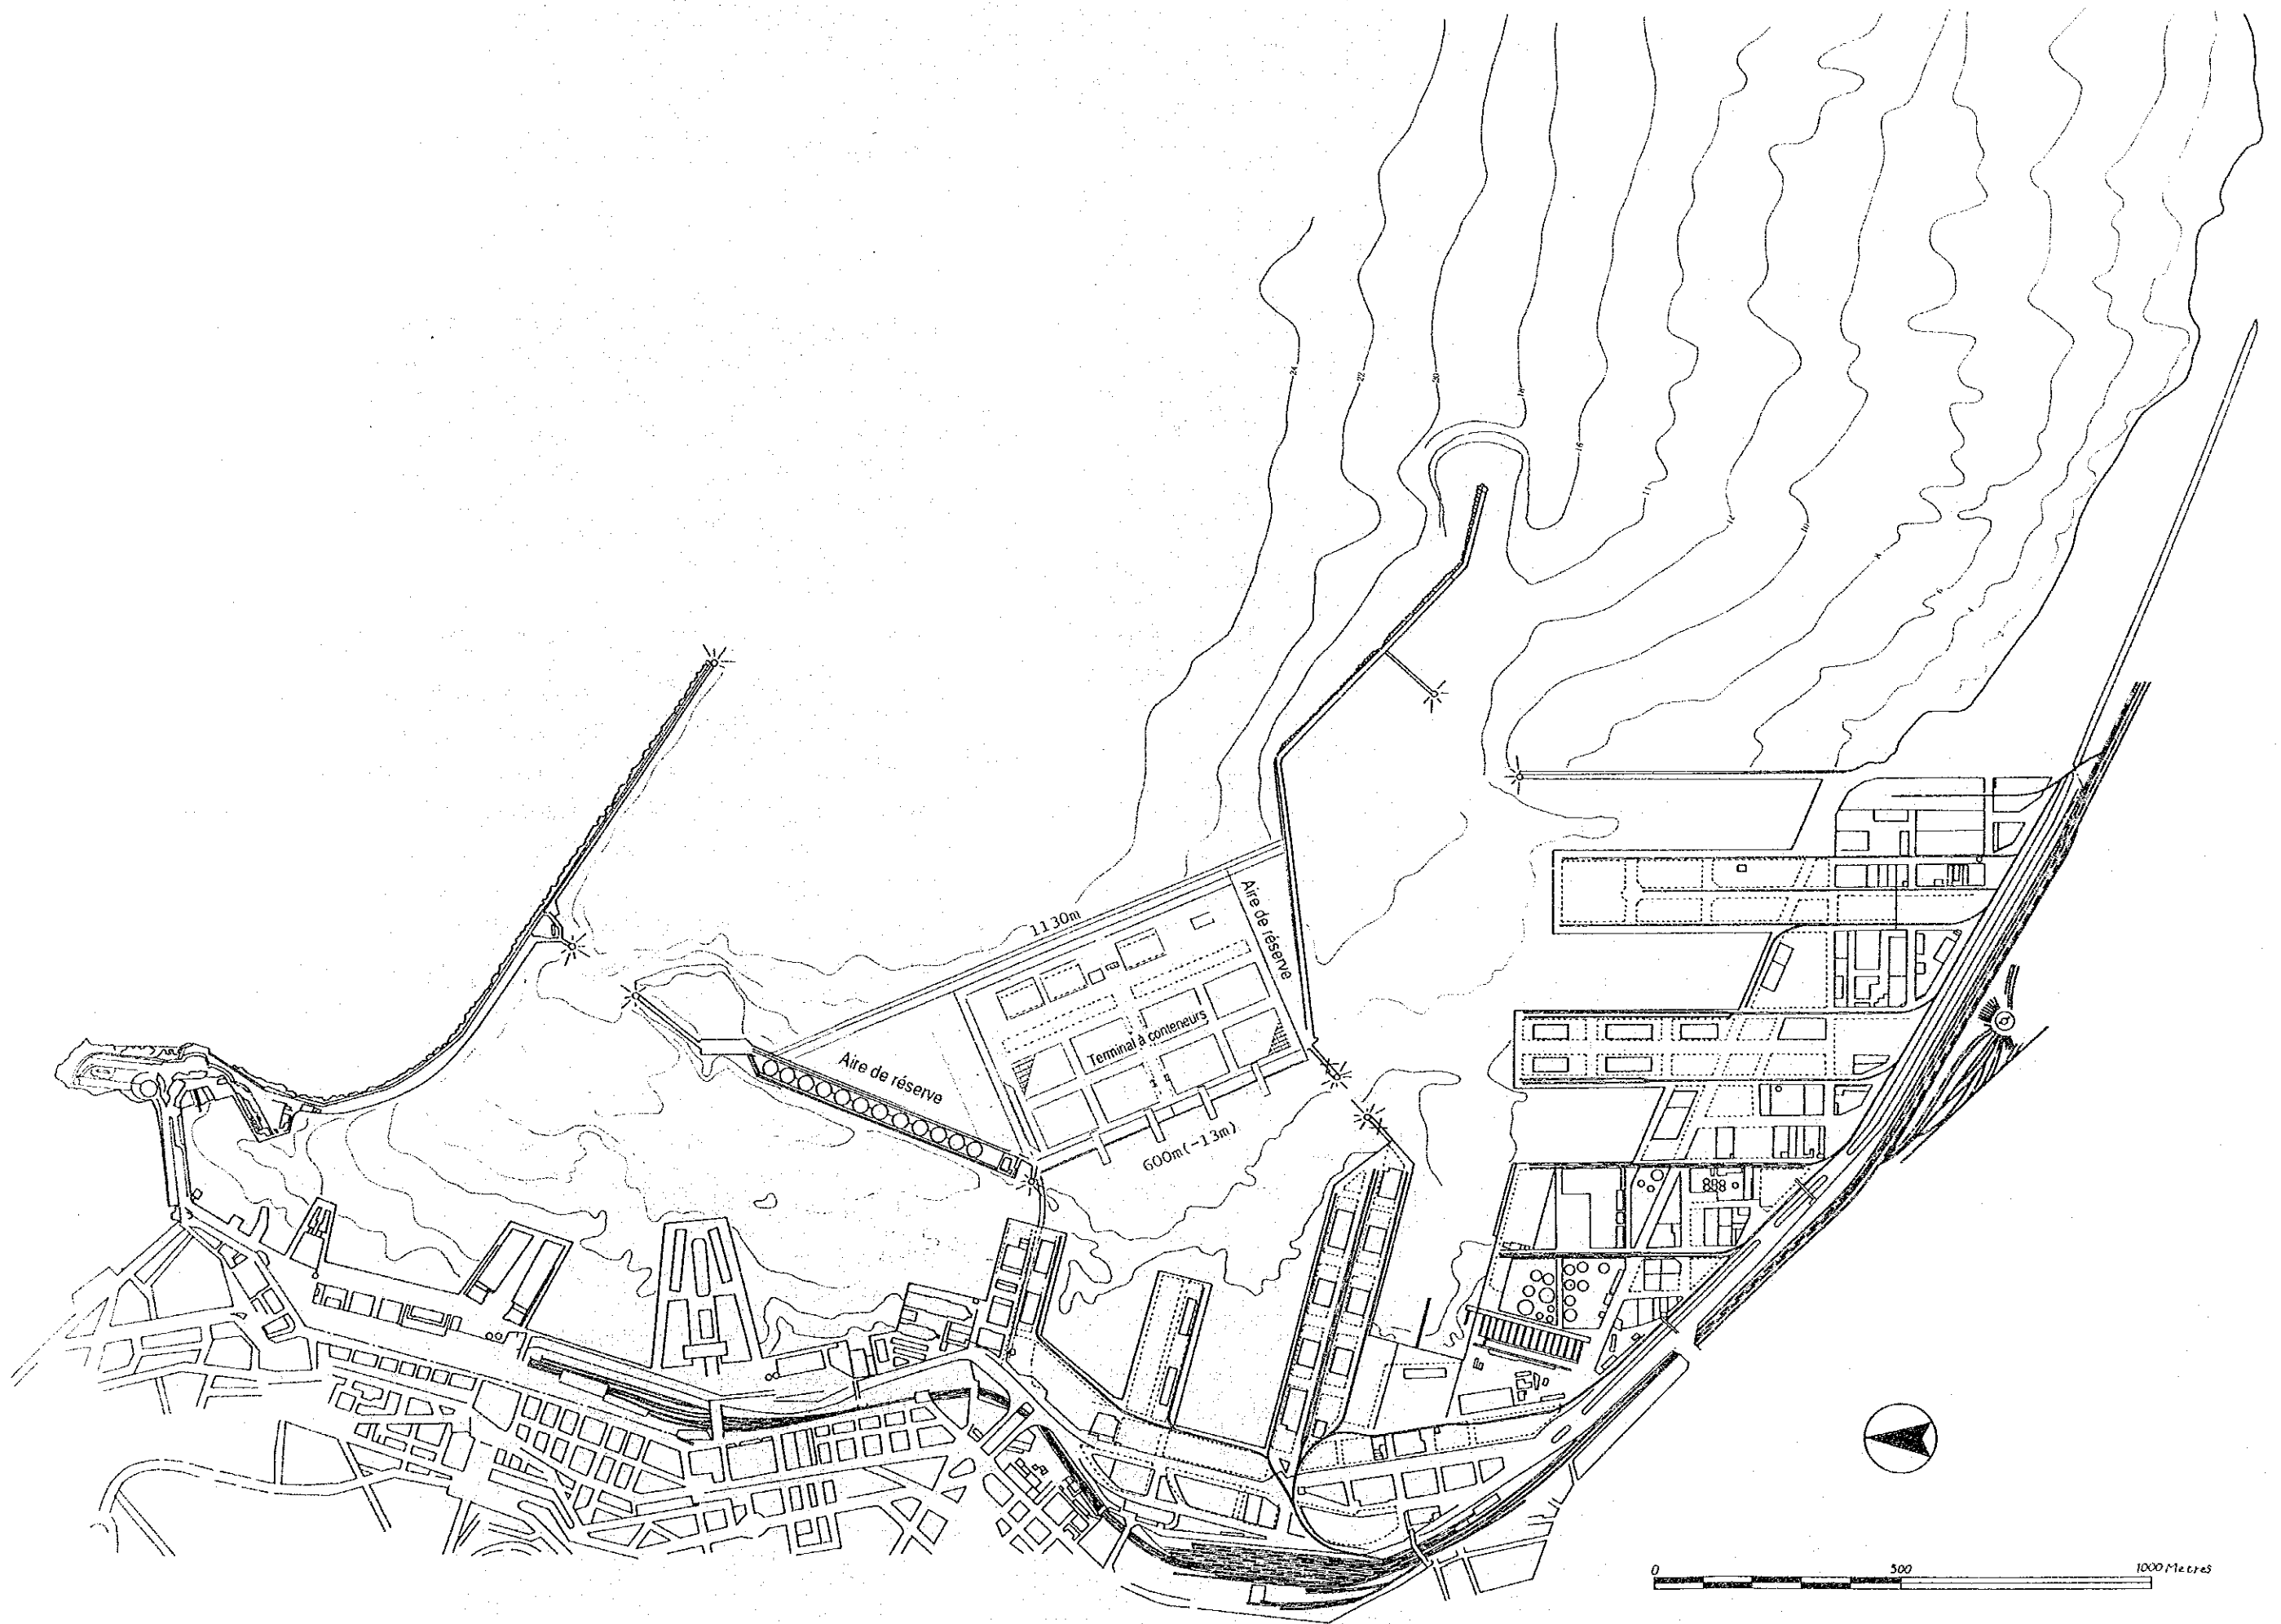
Plan de développement de substitution pour le terminal-2 (cas 3)
